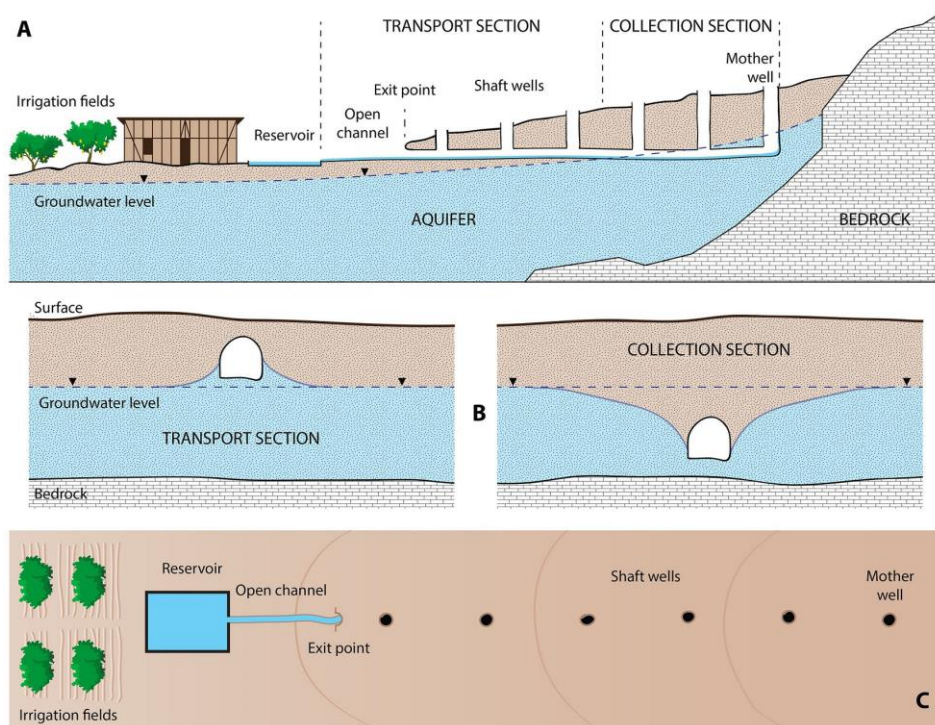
(A) Ilustración de una típica galería subterránea. (B) Sección transversal de una galería subterránea. (C) Vista en planta de una galería subterránea. Fuente: (Loctevout *et al.*, 2020)
